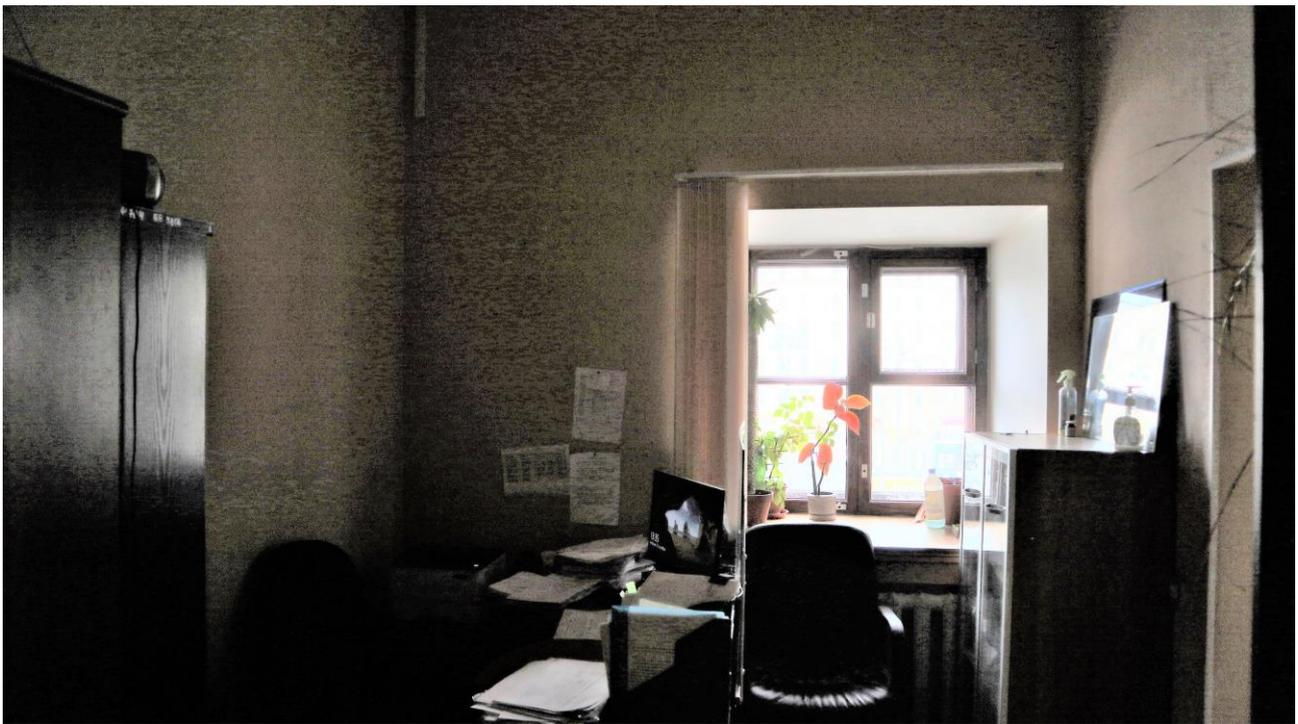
2 этаж, офисное помещение, 20Н (13).
